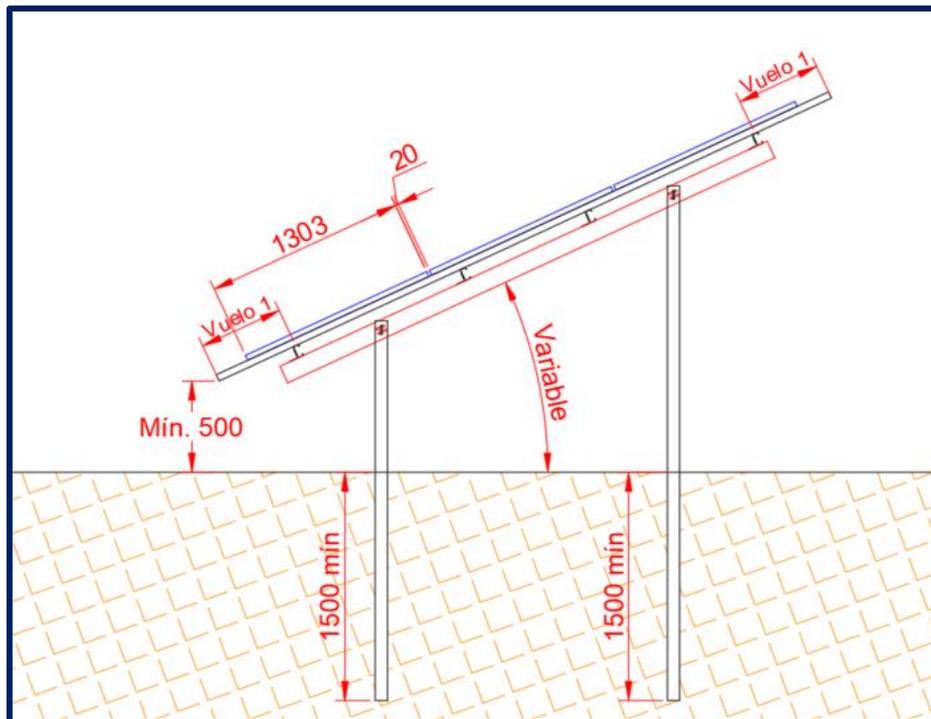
Dimensiones principales del pórtico de la estructura.
